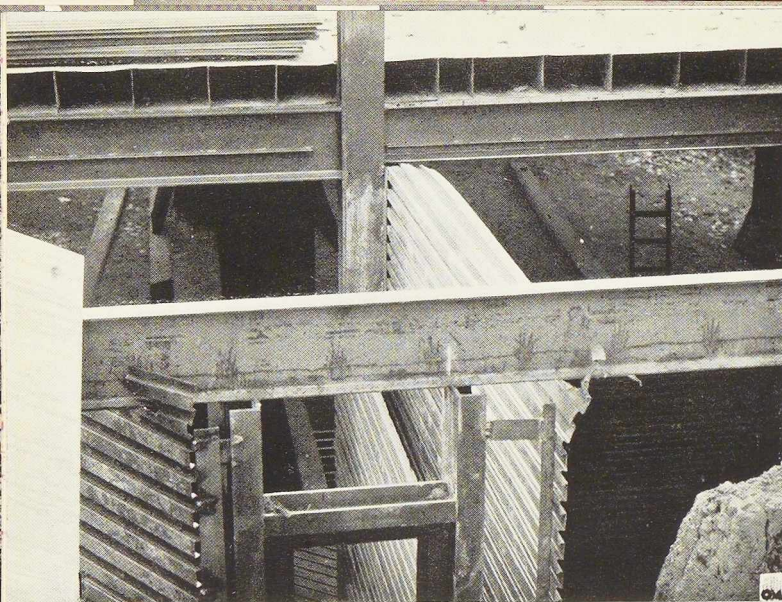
Détails de construction du sous-sol et du rez-de-chaussée. On note au sous-sol les cloisons doubles en tôle Am'Acier soudée à l'ossature, et, au rez-de-chaussée, le plancher constitué de panneaux de tôle plane de 2 mm, pliés en Z.
